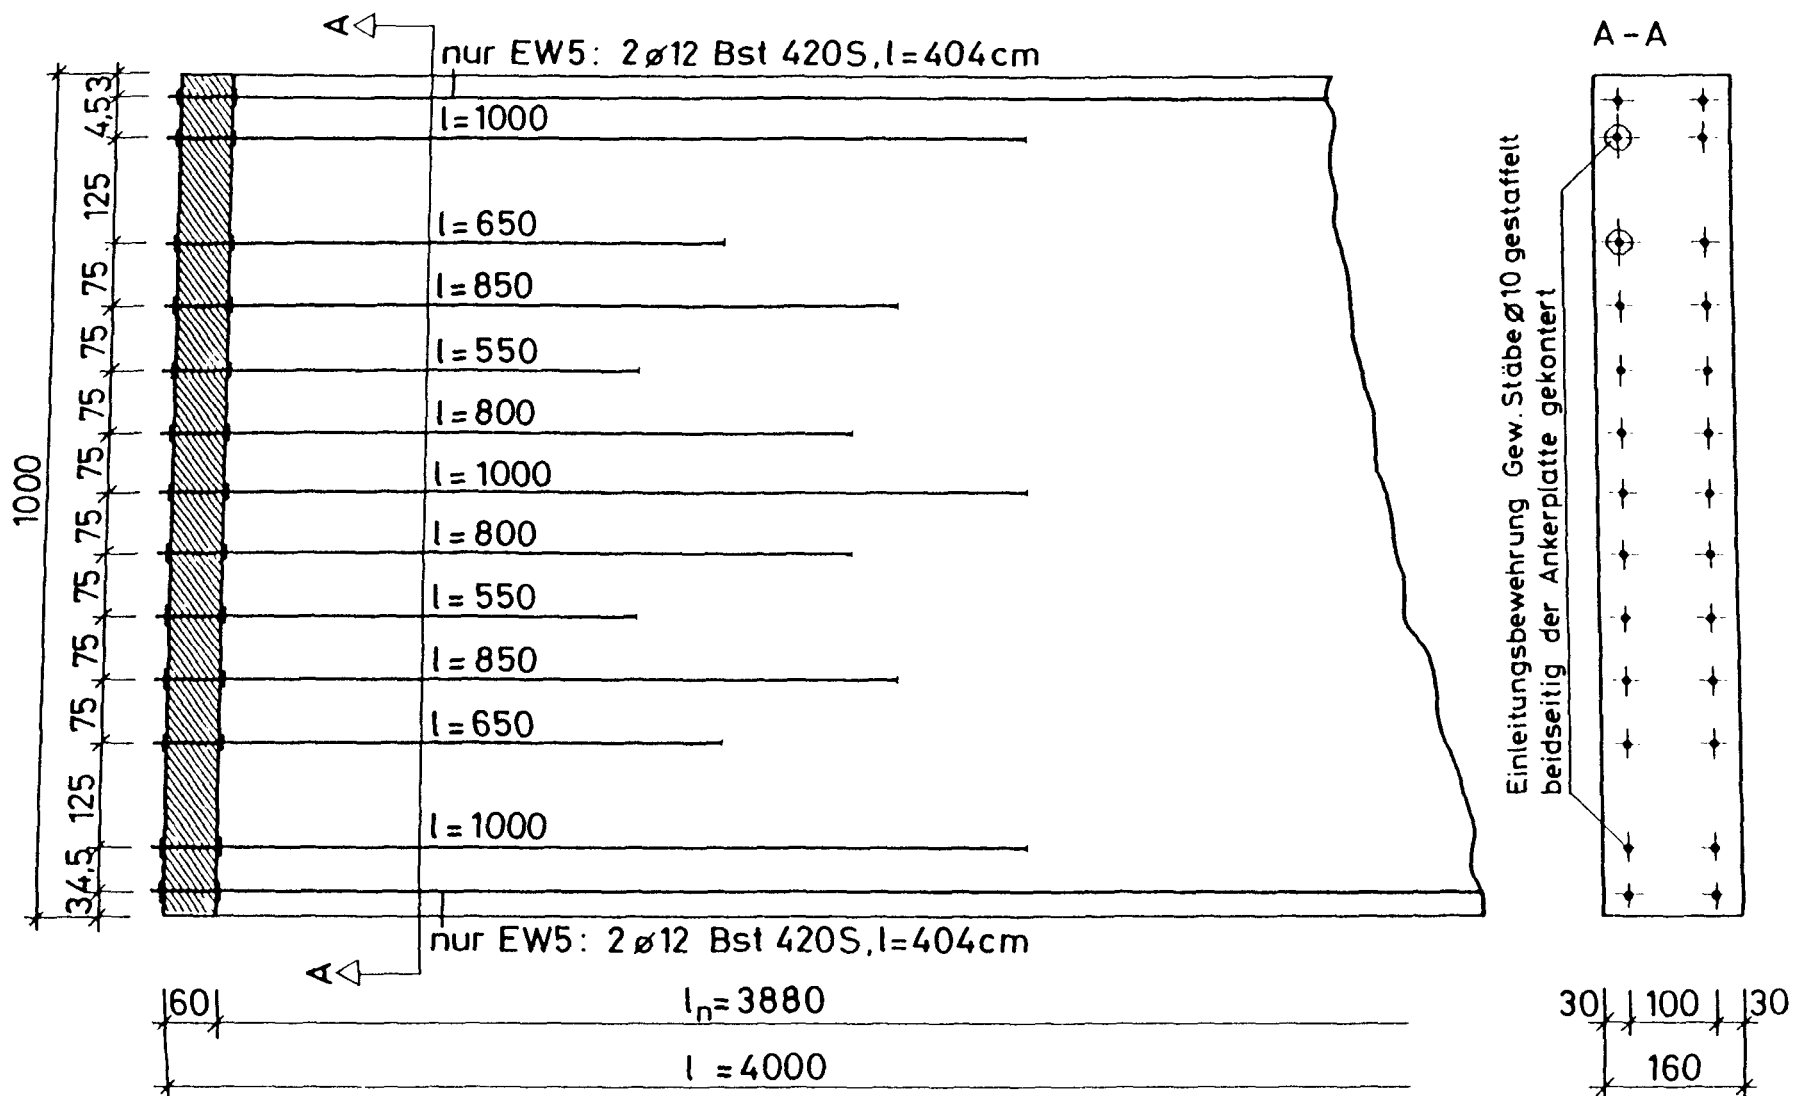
Einleitungsbewehrung und Zugbewehrung der Versuchskörper EW 1 - EW 6
